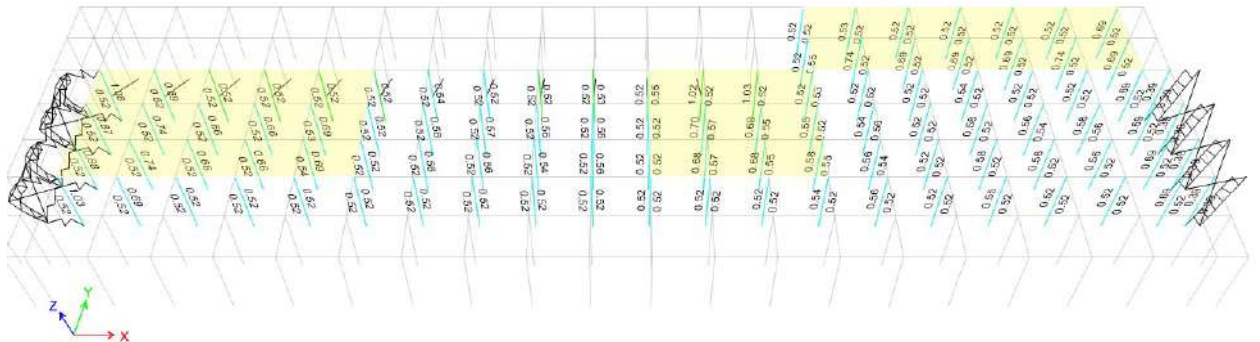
Pemeriksaan Strong Column Weak Beam Lantai Dua
